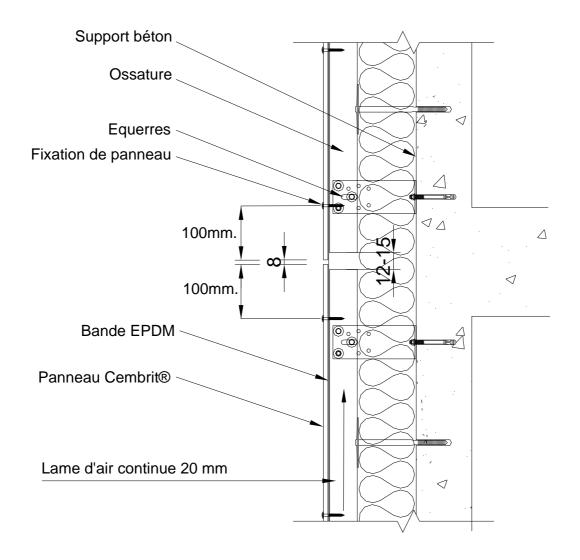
Joint de fractionnement au droit de chaque plancher - Coupe verticale
